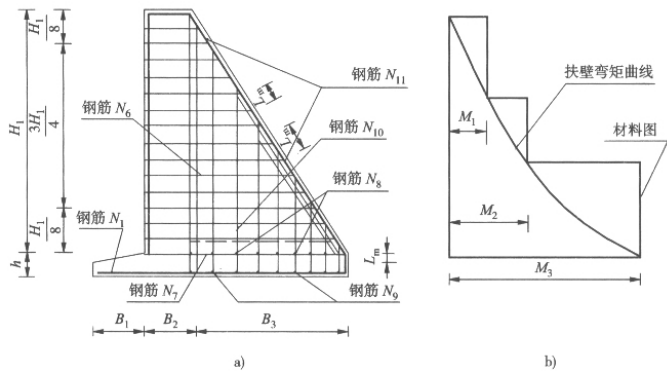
2—7 墙踵板和扶壁钢筋布置示意图
